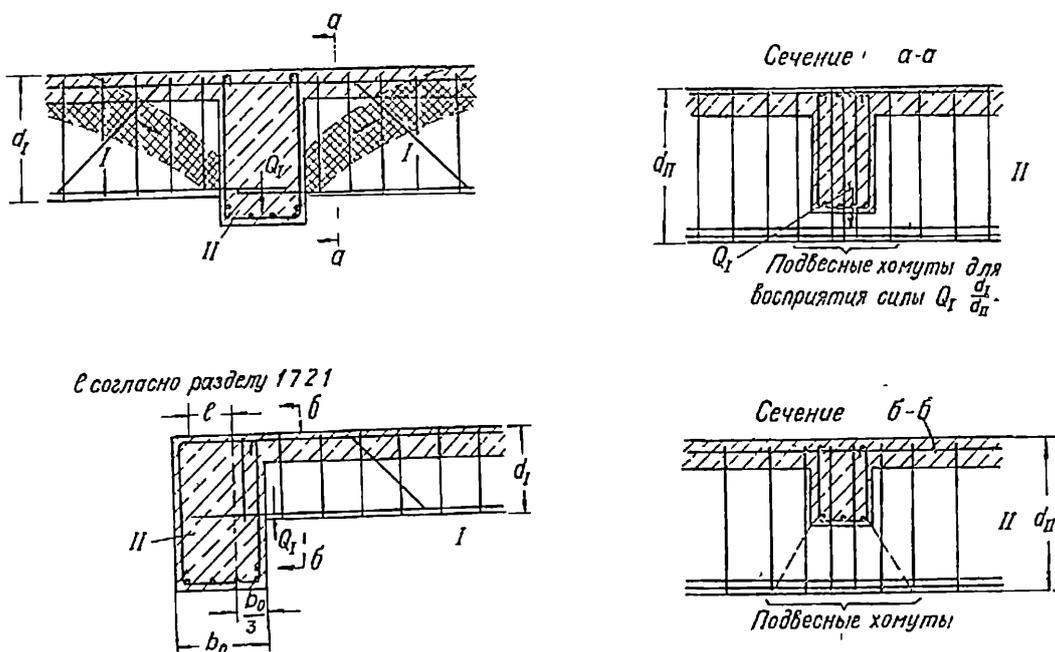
3. Подвесные хомуты в балке II, рассчитанные на усилие $Q_I \frac{d_I}{d_{II}}$ (Q_I - поперечная сила на опоре балки I)
